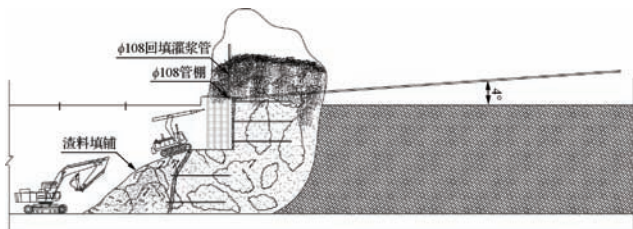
管棚平台回填、管棚施工、顶部空腔回填轻质混凝土示意图
